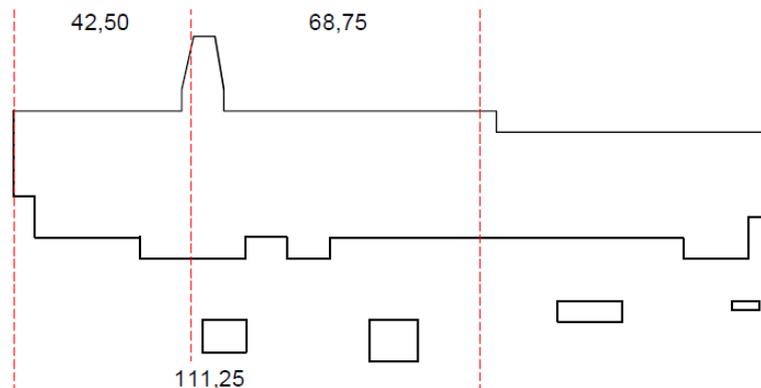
Planta baixa do térreo do aeroporto Santos Dumont (1937) segundo a razão de ouro.
